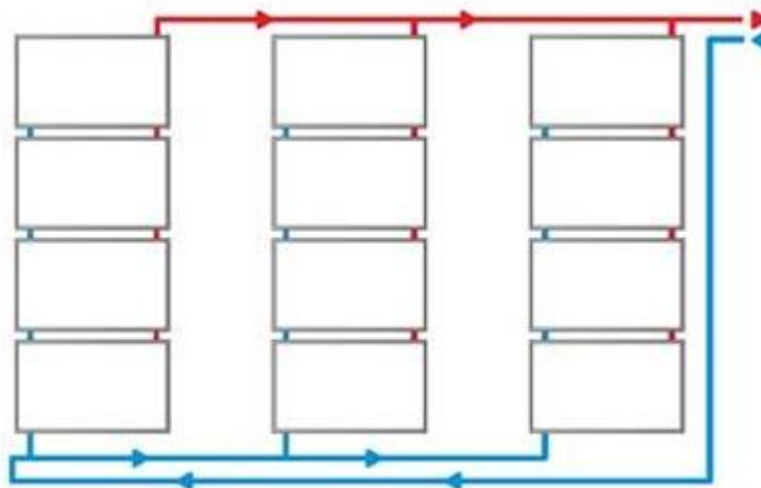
Esquema de baterías de paneles conectadas con ramal de impulsión invertido. Fuente:
